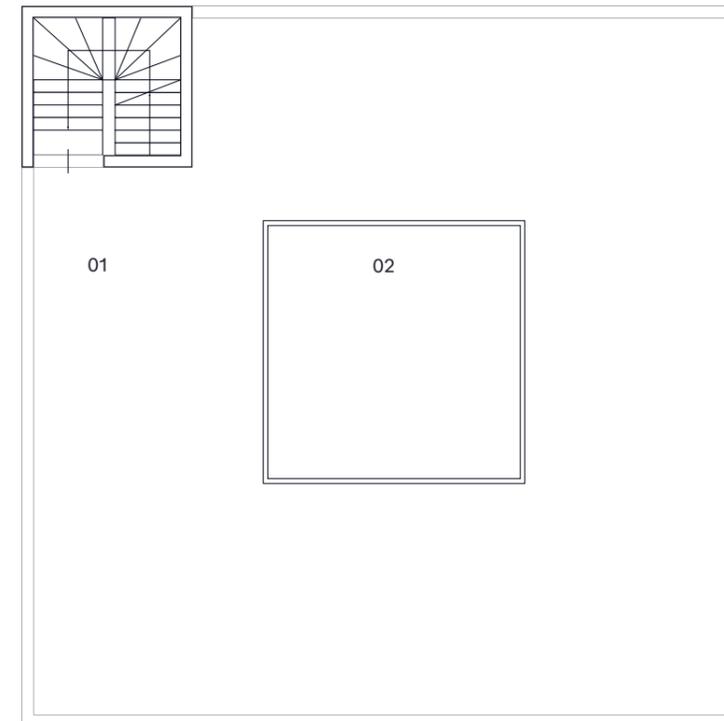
Grundriss Obergeschoss M 1:200
